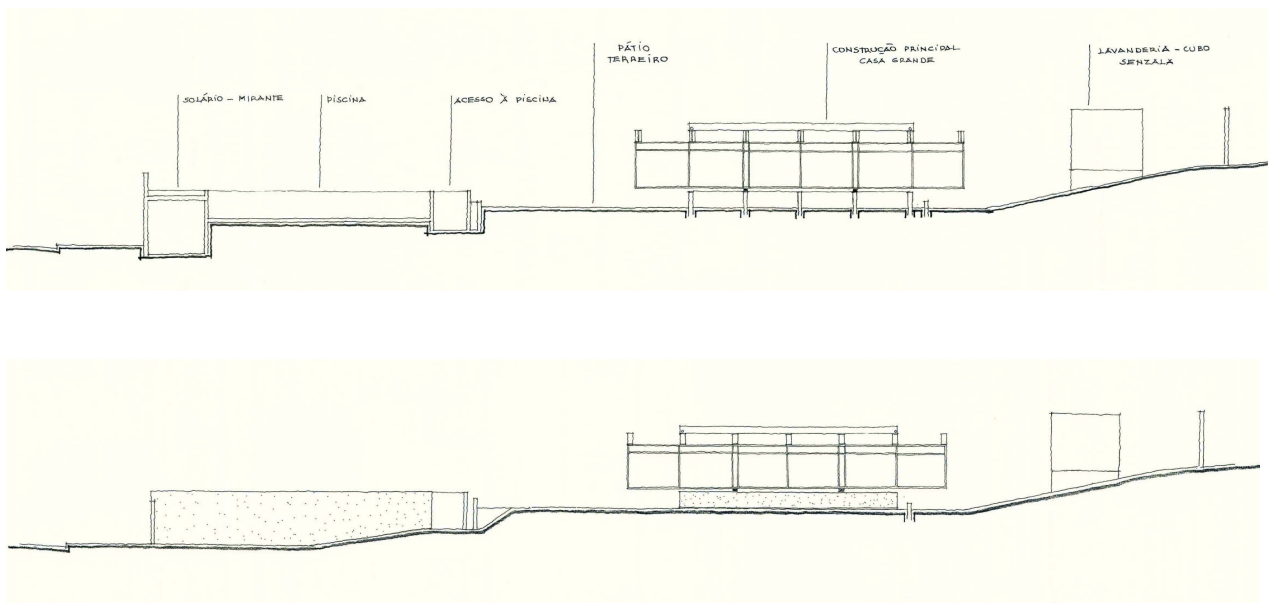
Corte e elevação – res. Paulo Roberto da Costa Santos
